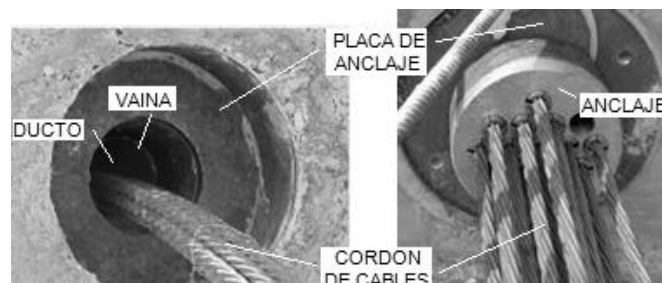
Detalle de ducto, vaina, cordón de cables, anclaje y placa de anclaje [29]
